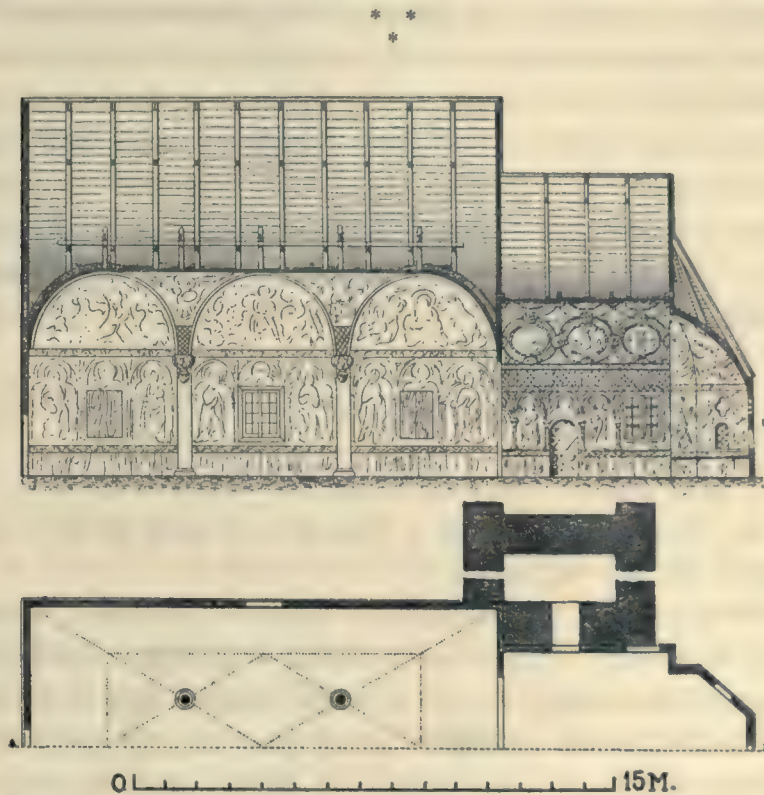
EDSHULT. — PLAN ET COUPE DE L'ÉGLISE. RECONSTRUCTION PAR N. M. MANDELORÉN.
